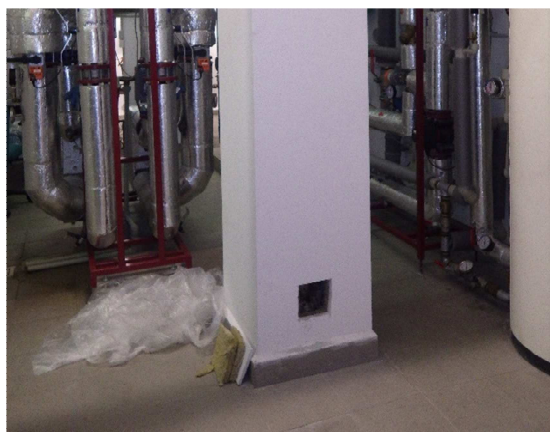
sonda NS-B9-obnažená část, Foto č.44--sonda NS-C1-celkový pohled;
